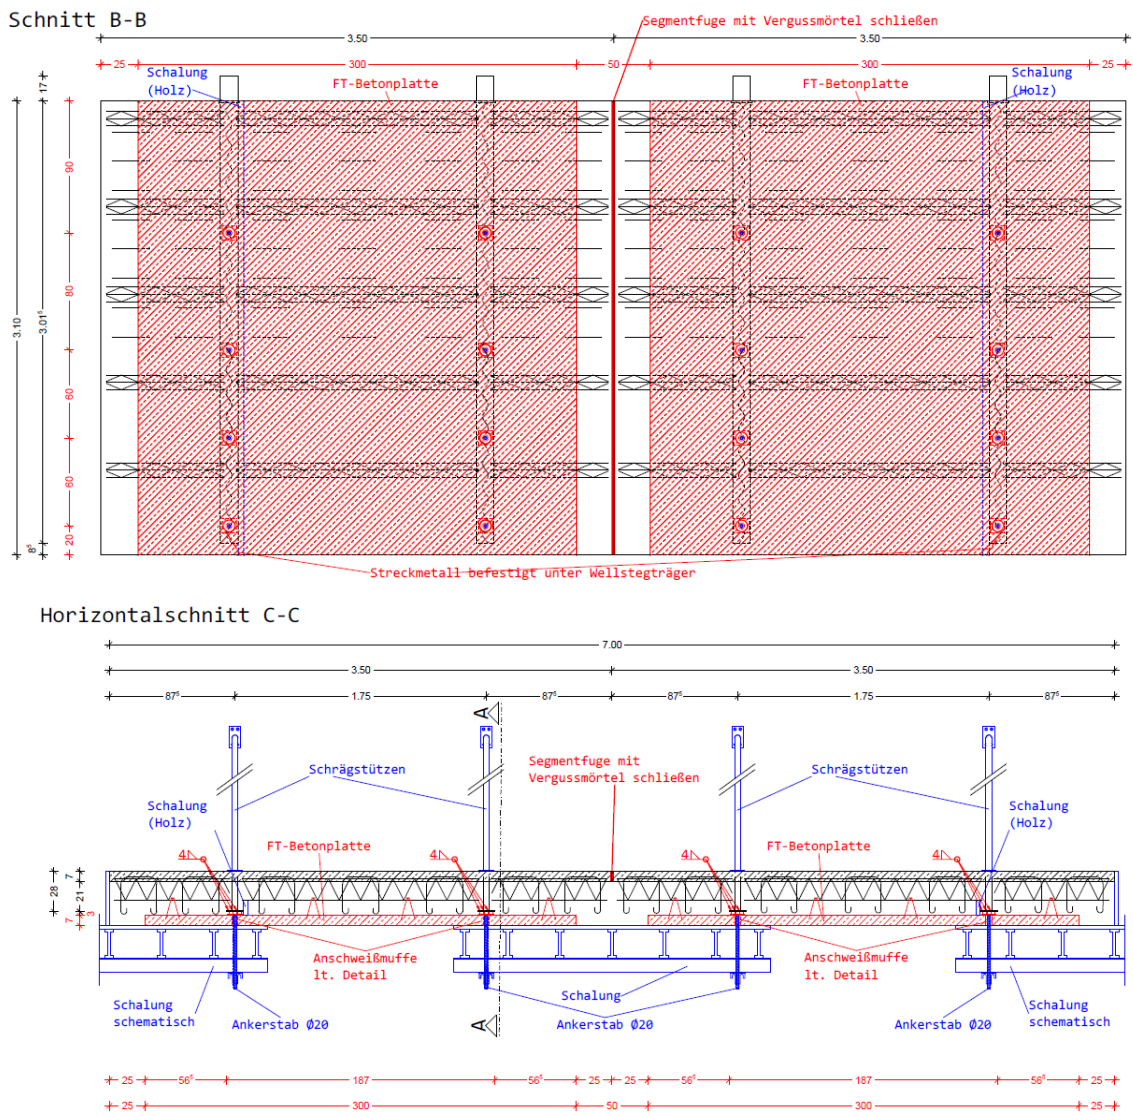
Ergänzungsvariante 3: Fertigteilplatten mit Schalung an den Stahlträgern angeschraubter Schalung im Längsschnitt und Horizontalschnitt
